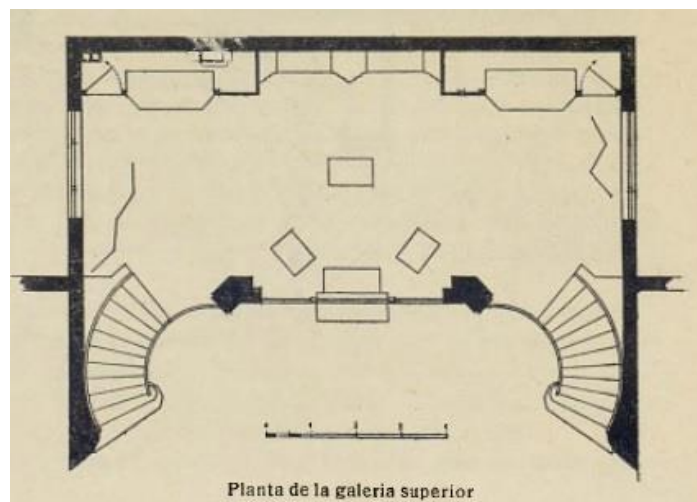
Planta del Pavelló dels Artistes Reunits, 1929
